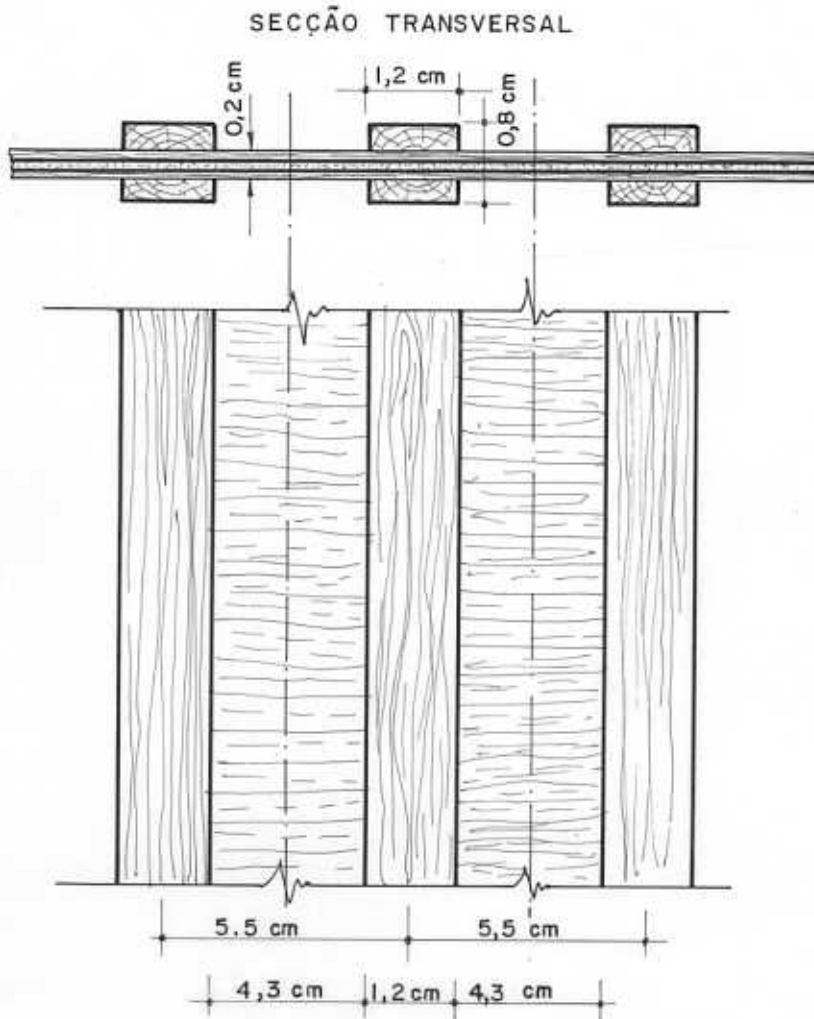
SECÇÃO TRANSVERSAL DA PAREDE DO SILO
